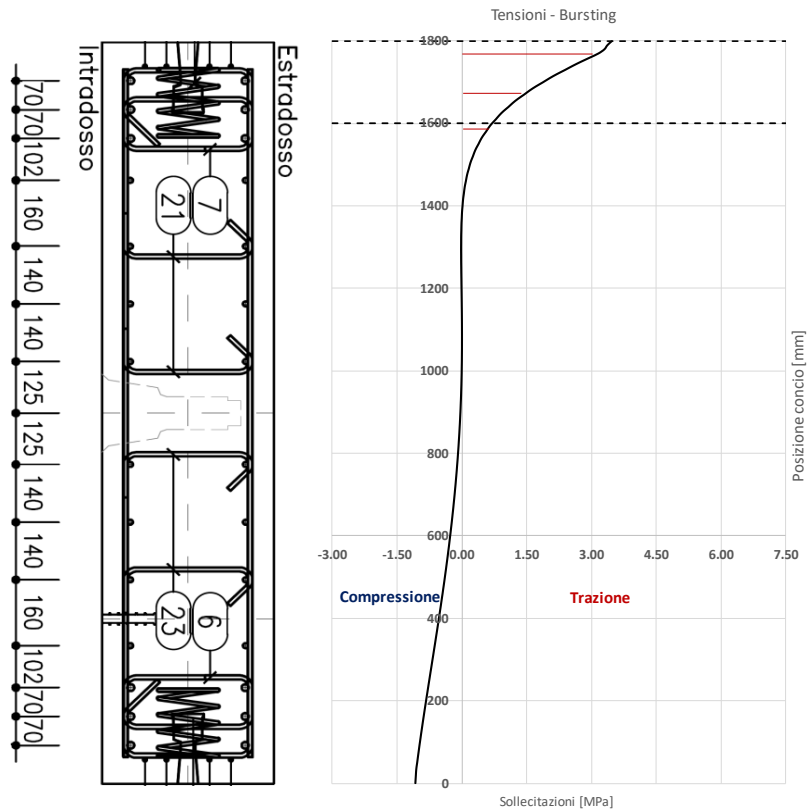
Andamento delle sollecitazioni effetto spalling tra le scarpe di spinta
